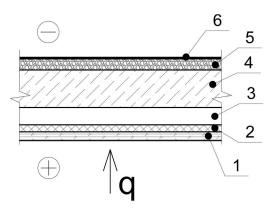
Схема конструкции чердачного покрытия: 1 – цементно-магниевая плита; 2 – экранная изоляция; 3 – воздушная прослойка; 4 – железобетонная плита; 5 – слой керамзитобетона; 6 – гидроизоляционный слой
